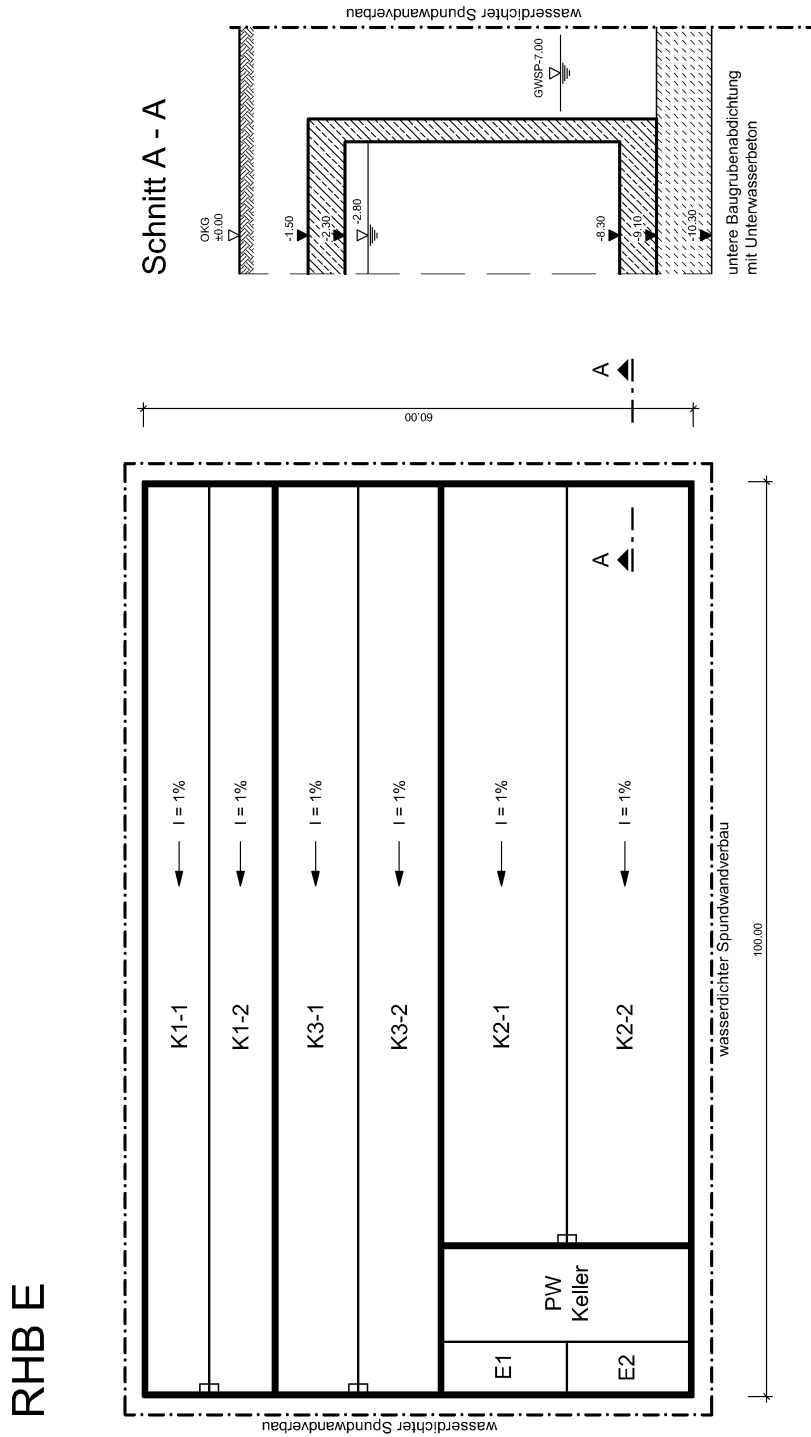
Grundriss und Schnitt RHB E
